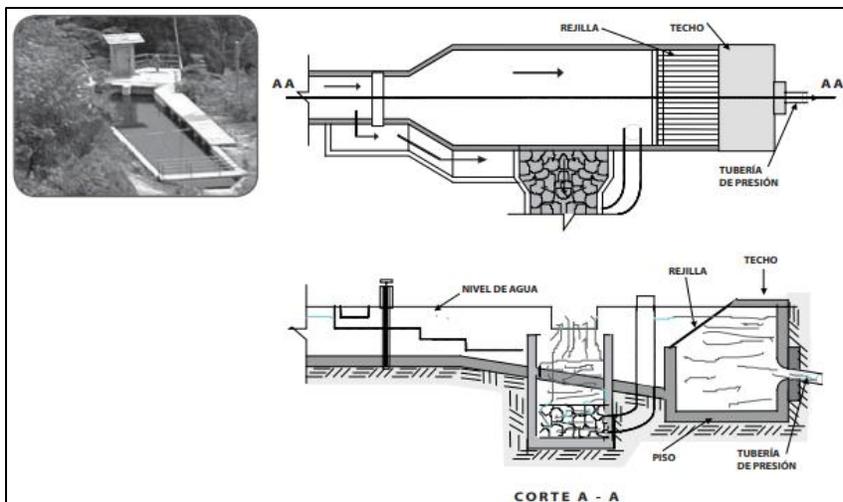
Cámara de carga en planta y en sección transversal con sus partes.
